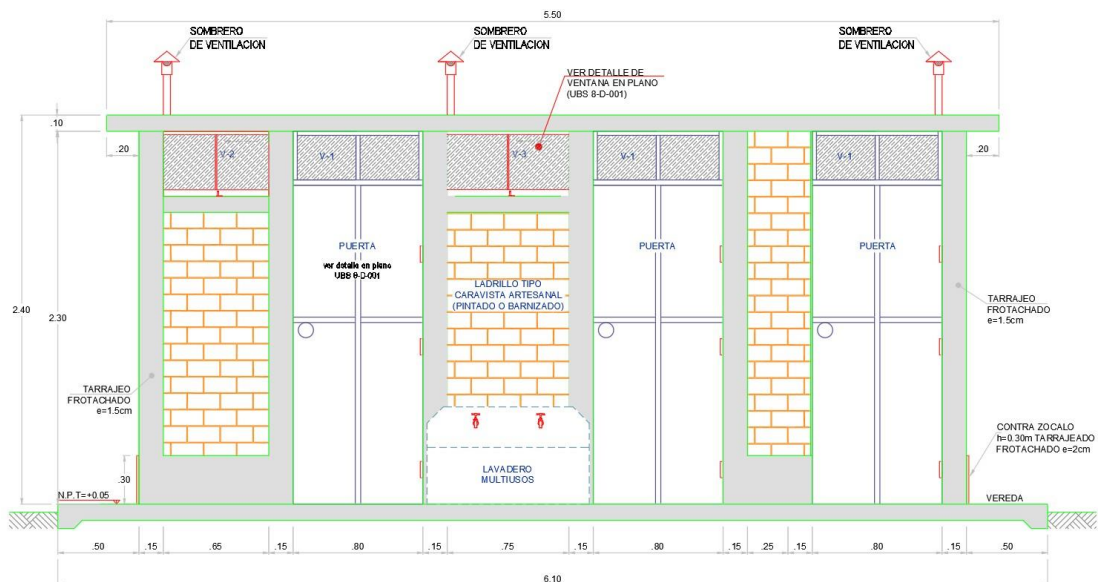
Propuesta de Plano frontal de la UBS en la I.E.
